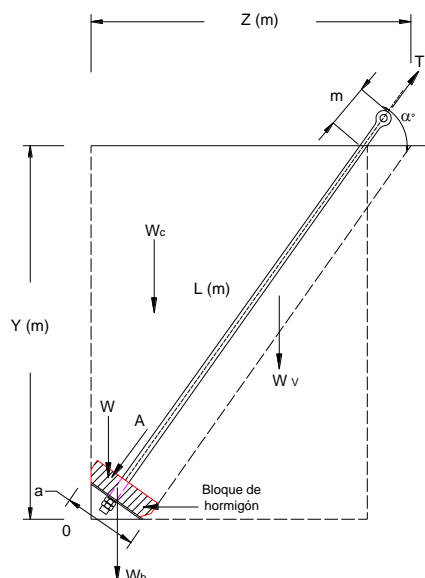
Ancla de hormigón tipo bloque (acercamiento)
